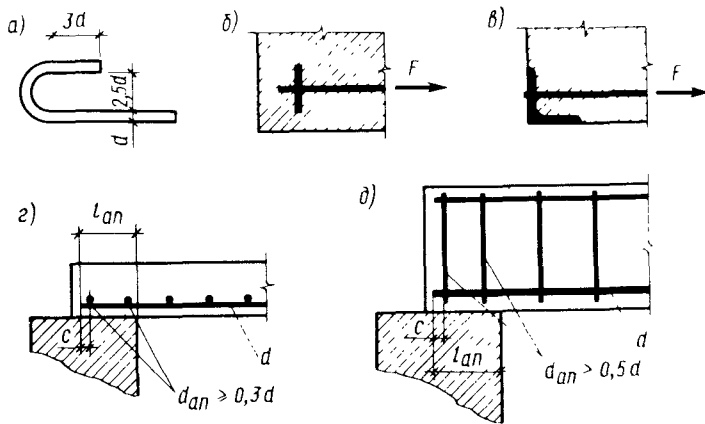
Анкеровка ненапрягаемой арматуры: а — круглых гладких стержней в вязаных каркасах; б — шайбами; в — уголками; с — на крайних свободных опорах плит; д — то же, балок
